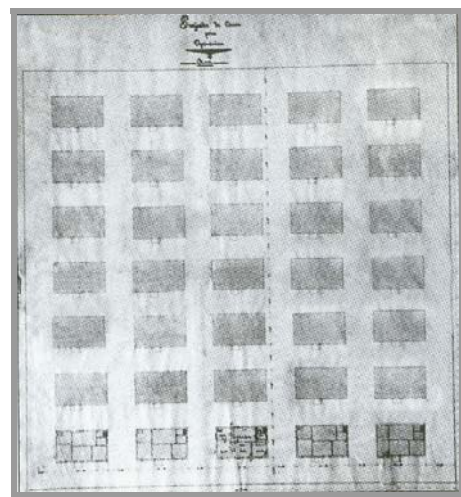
Primeira proposta de conjunto habitacional horizontal de casas isoladas.
